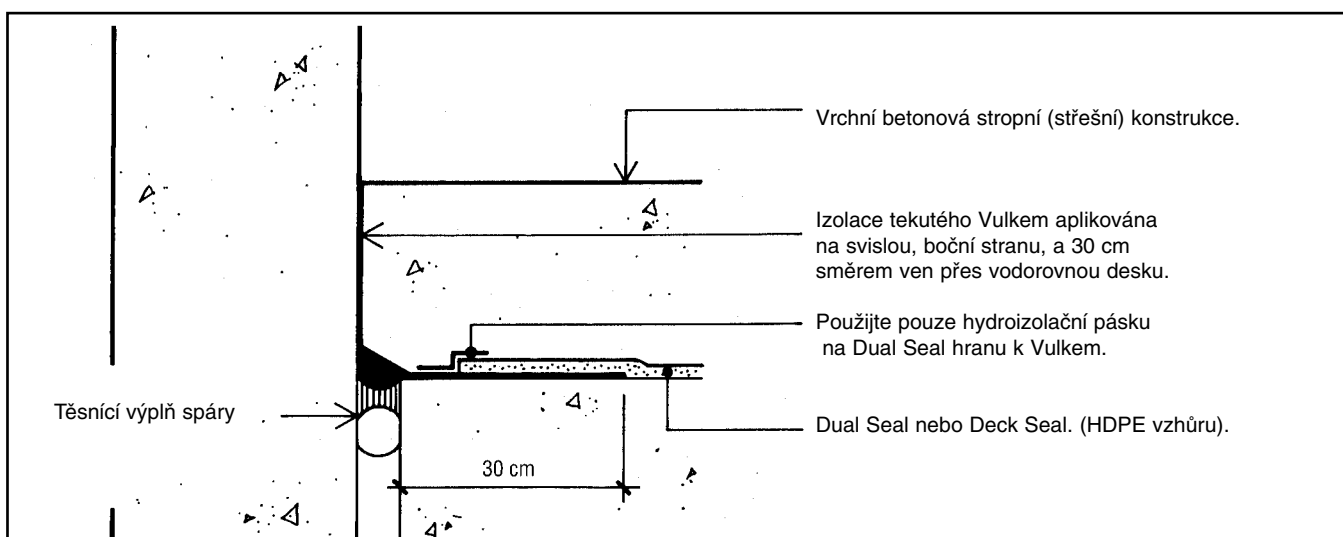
Parapet na hraně střechy (střešní římsa).
